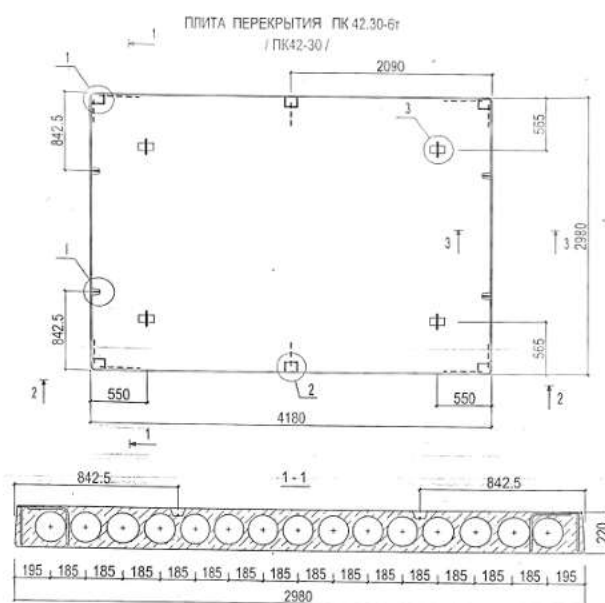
Многопустотная плита перекрытия ПК 42.30-6т серии
